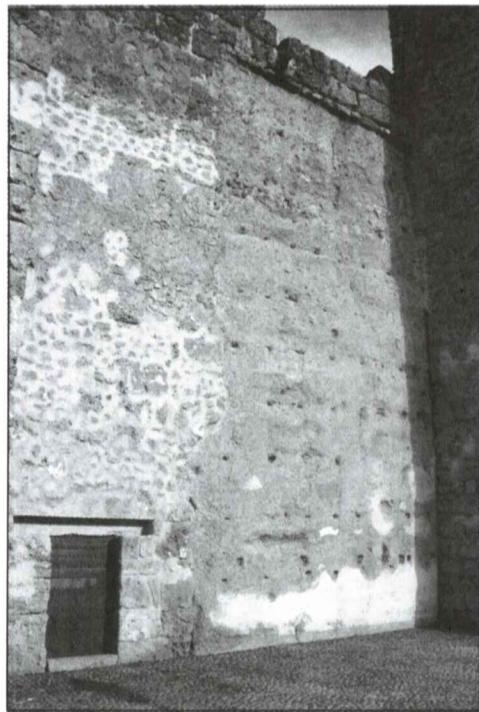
Muralla islámica construida con la técnica de tapial, en hormigón (siglos XII-XIII). A su izquierda, la poterna.
